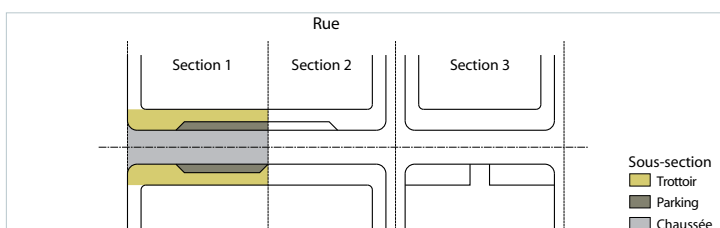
Subdivision du réseau routier en sections et sous-sections de route
